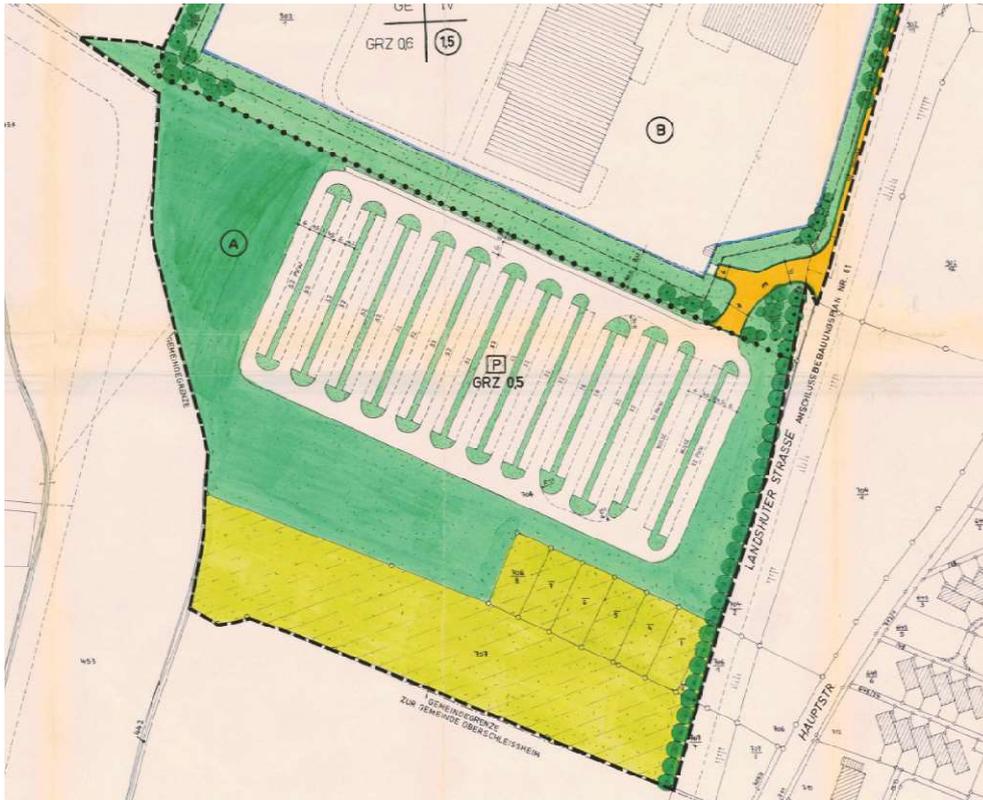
Ausschnitt Bauungsplan Nr. 79a, südlicher Teil, Plangebiet Bauungsplan Nr. 79c
